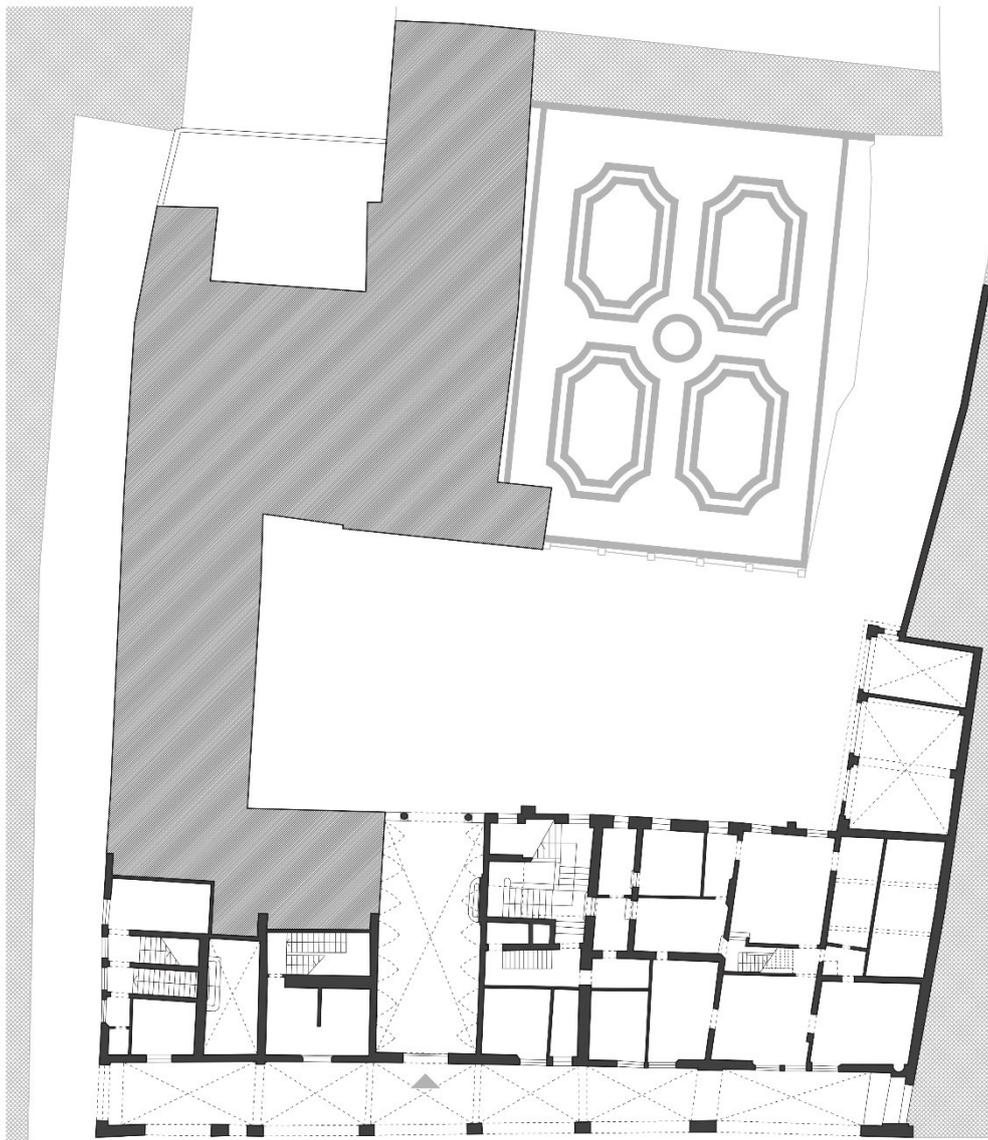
Palazzo Selvatico, Padova, via Vescovado. Pianta del piano mezzino.
